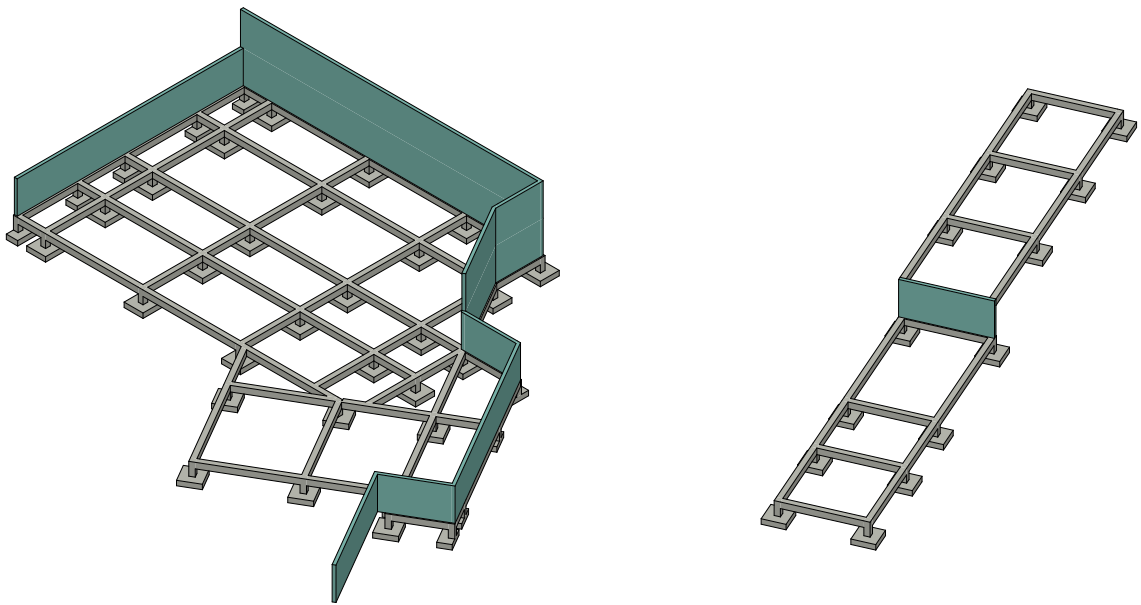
Requisitos para zapatas aisladas. Elaborado: Autores.
